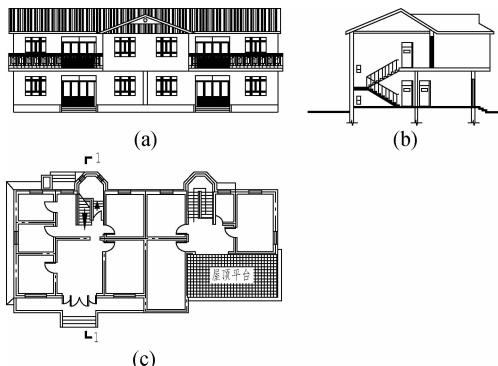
使用 AutoCAD 绘制的建筑施工图
